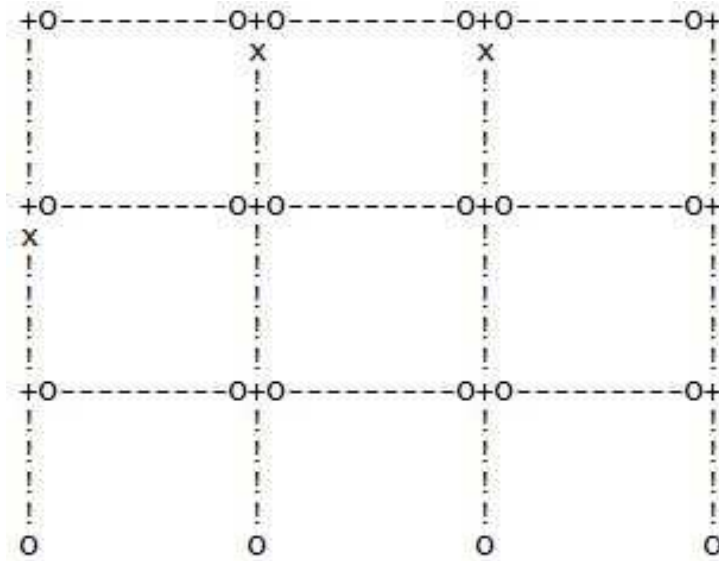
Mecanismo de colapso "columna fuerte-viga débil". Tipo de pórtico 1
